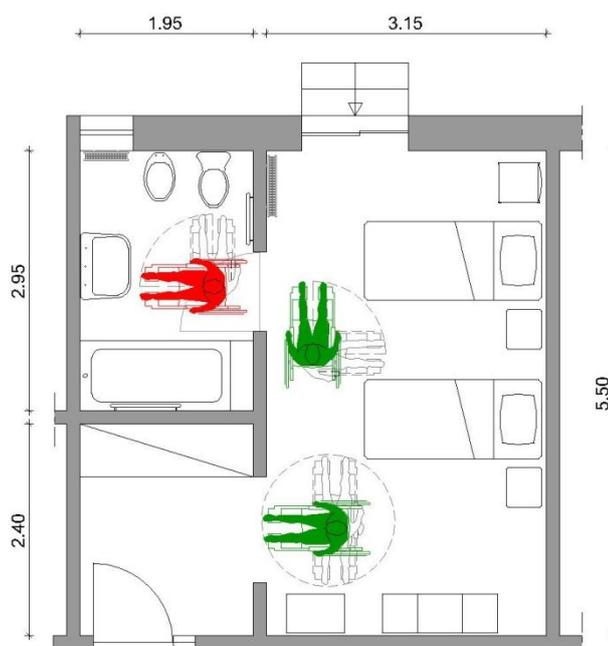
ILPI 1 - 3º pavimento - Planta baixa quarto e banho privado.
